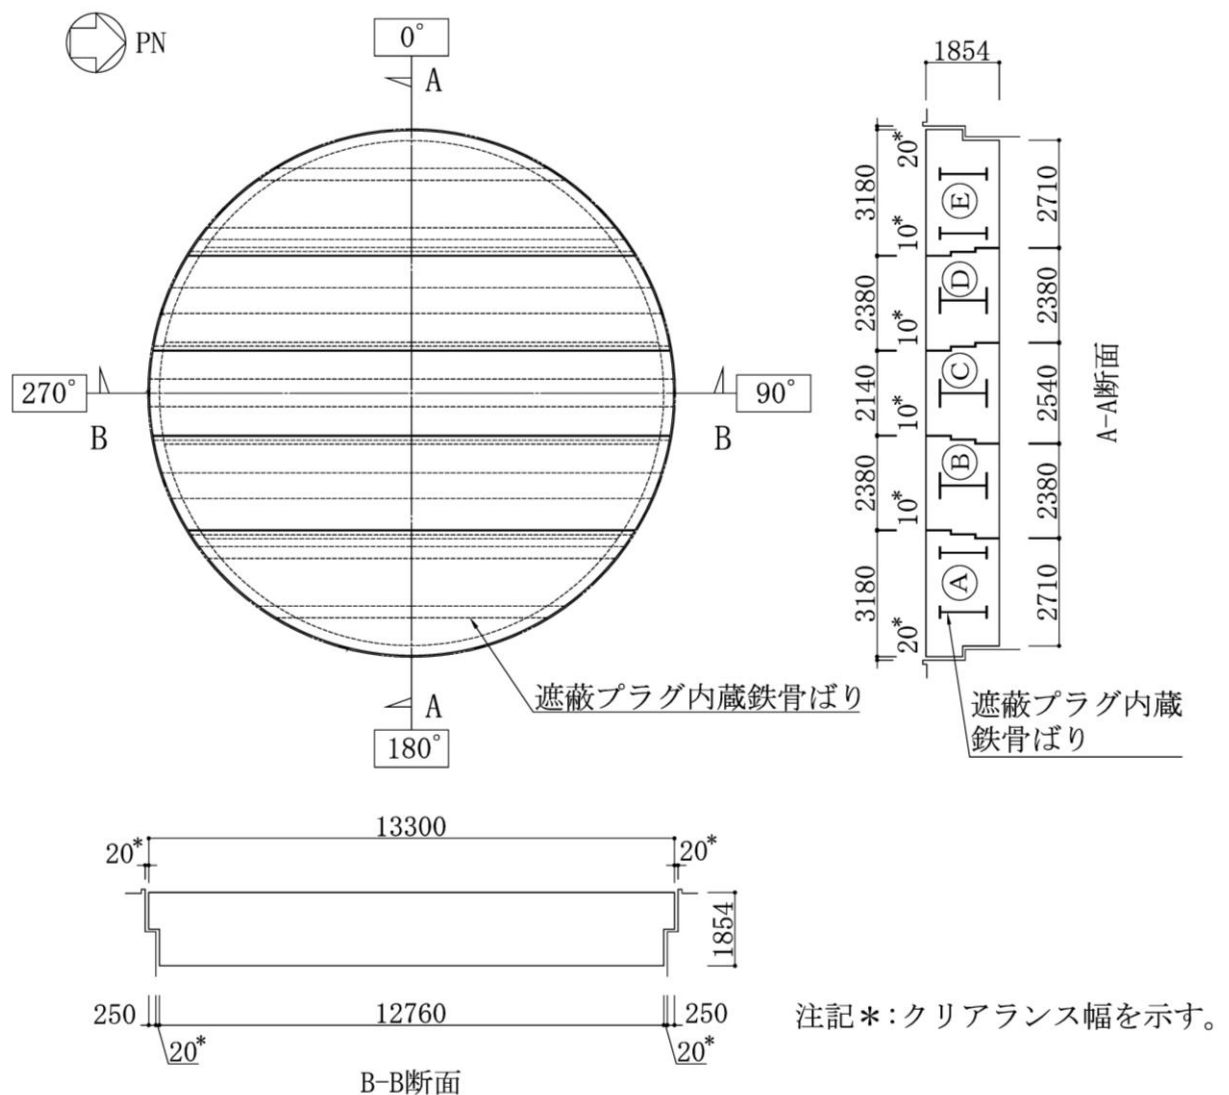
原子炉ウェル遮蔽プラグ概要図 (単位: mm)
